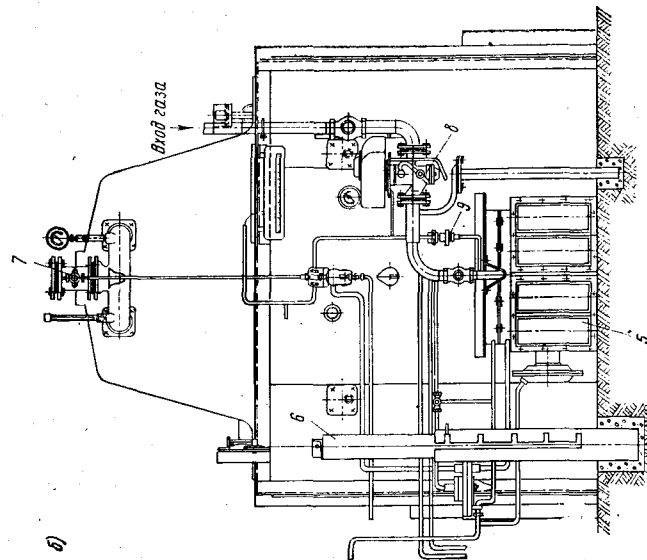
Котел «Универсал-6» с форкамерной горелкой для сжигания газа
